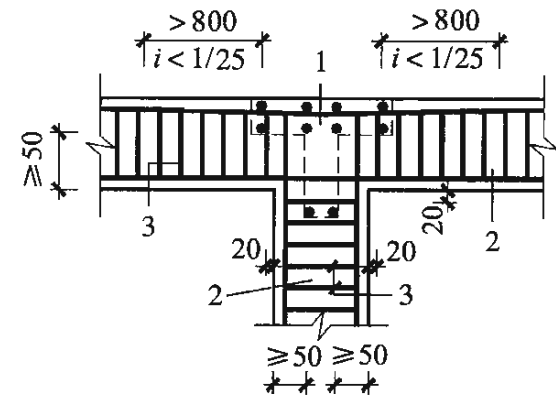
框架梁纵向钢筋从柱筋外侧伸入节点时箍筋的布置
